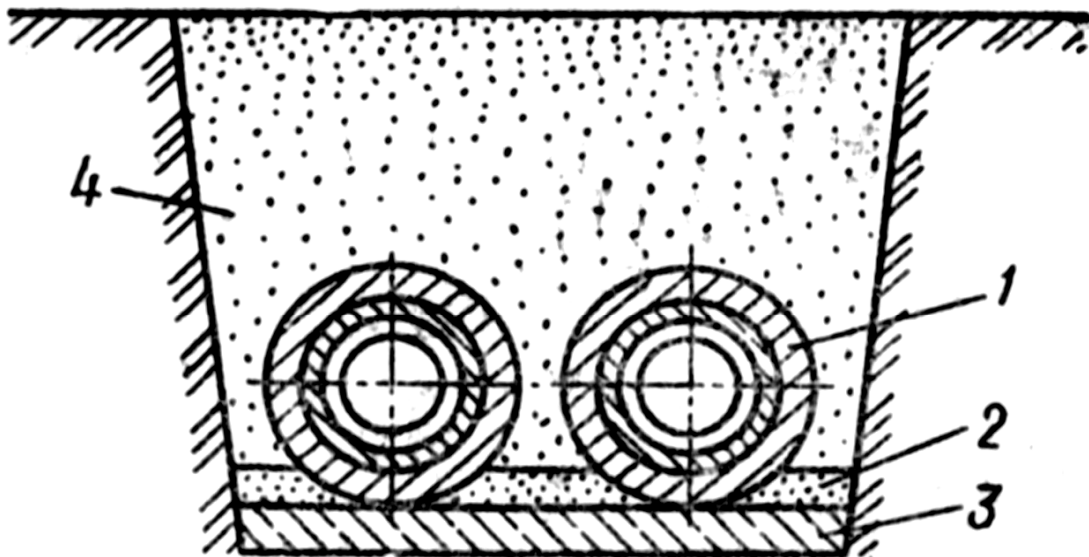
Бесканальная прокладка теплопроводов в монолитных оболочках из армированного пенобетона
